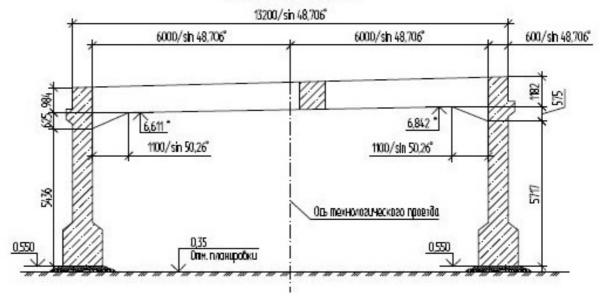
Поперечный разрез путепровода тоннельного типа
